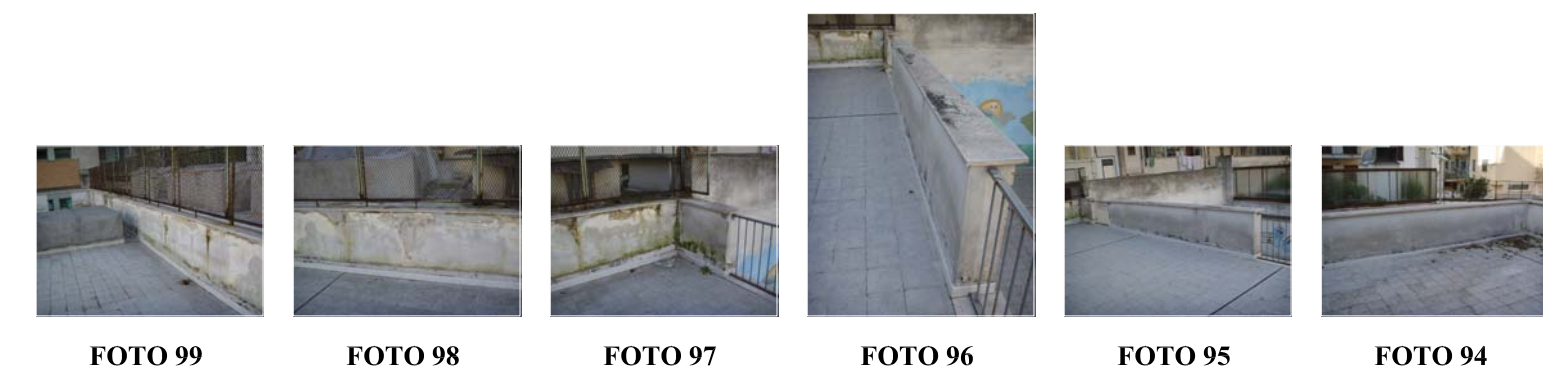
FOTO 98 FOTO 97 FOTO 96 FOTO 95 FOTO 94
